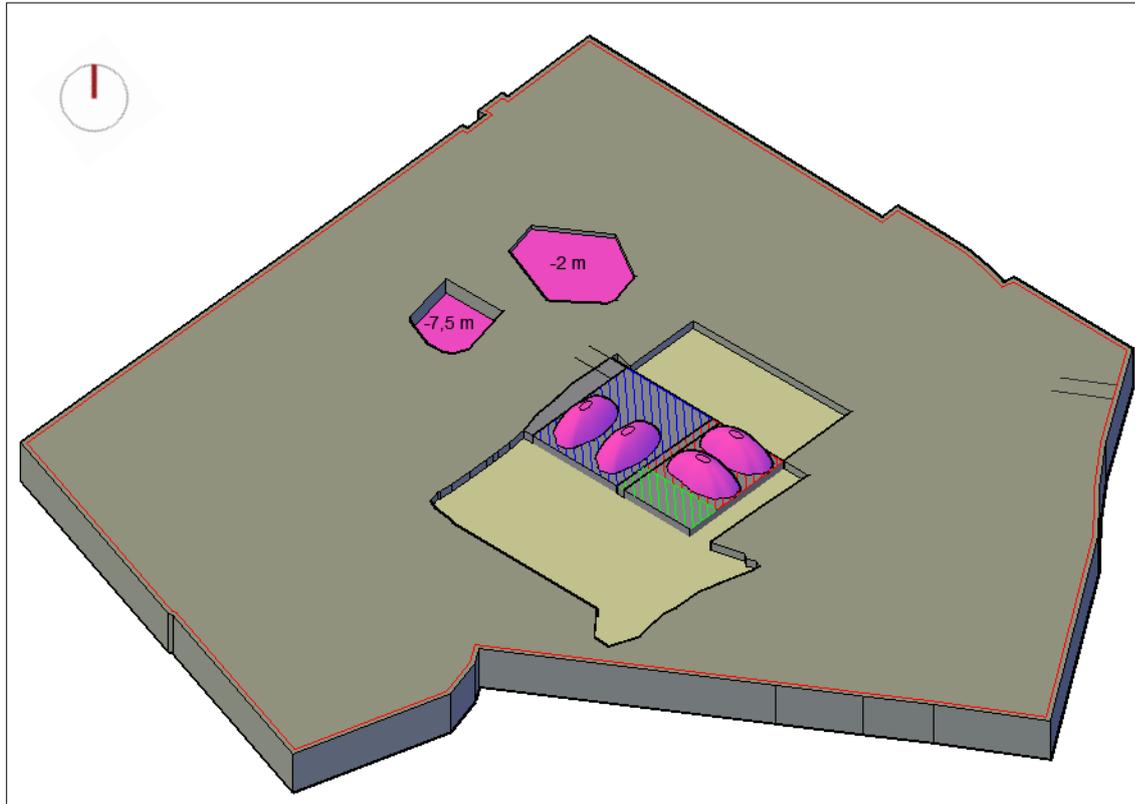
modellazione 3D scavi suolo profondo (>1 m da p.c.)
